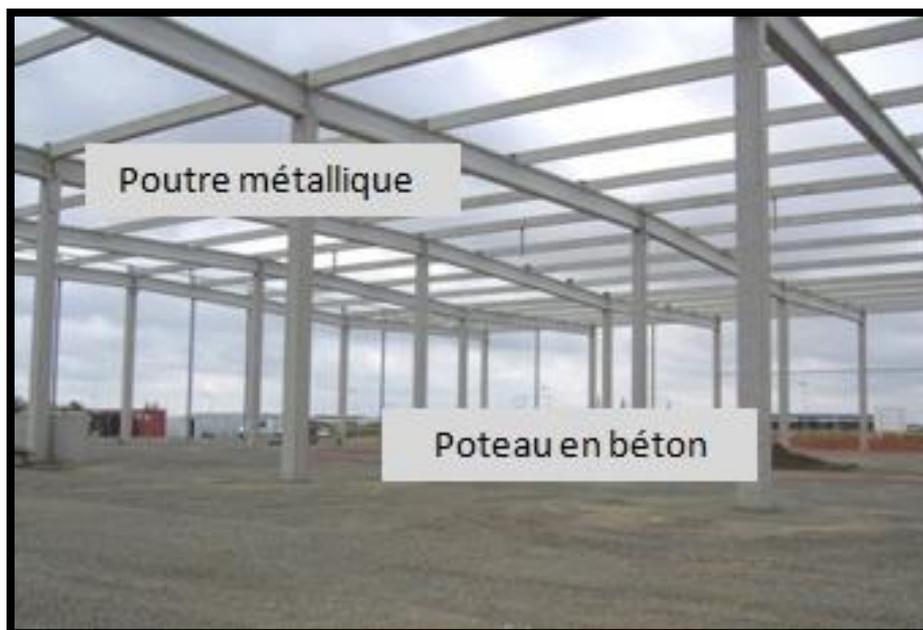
Système constructif mixte (poutre métallique, poteau en béton)
